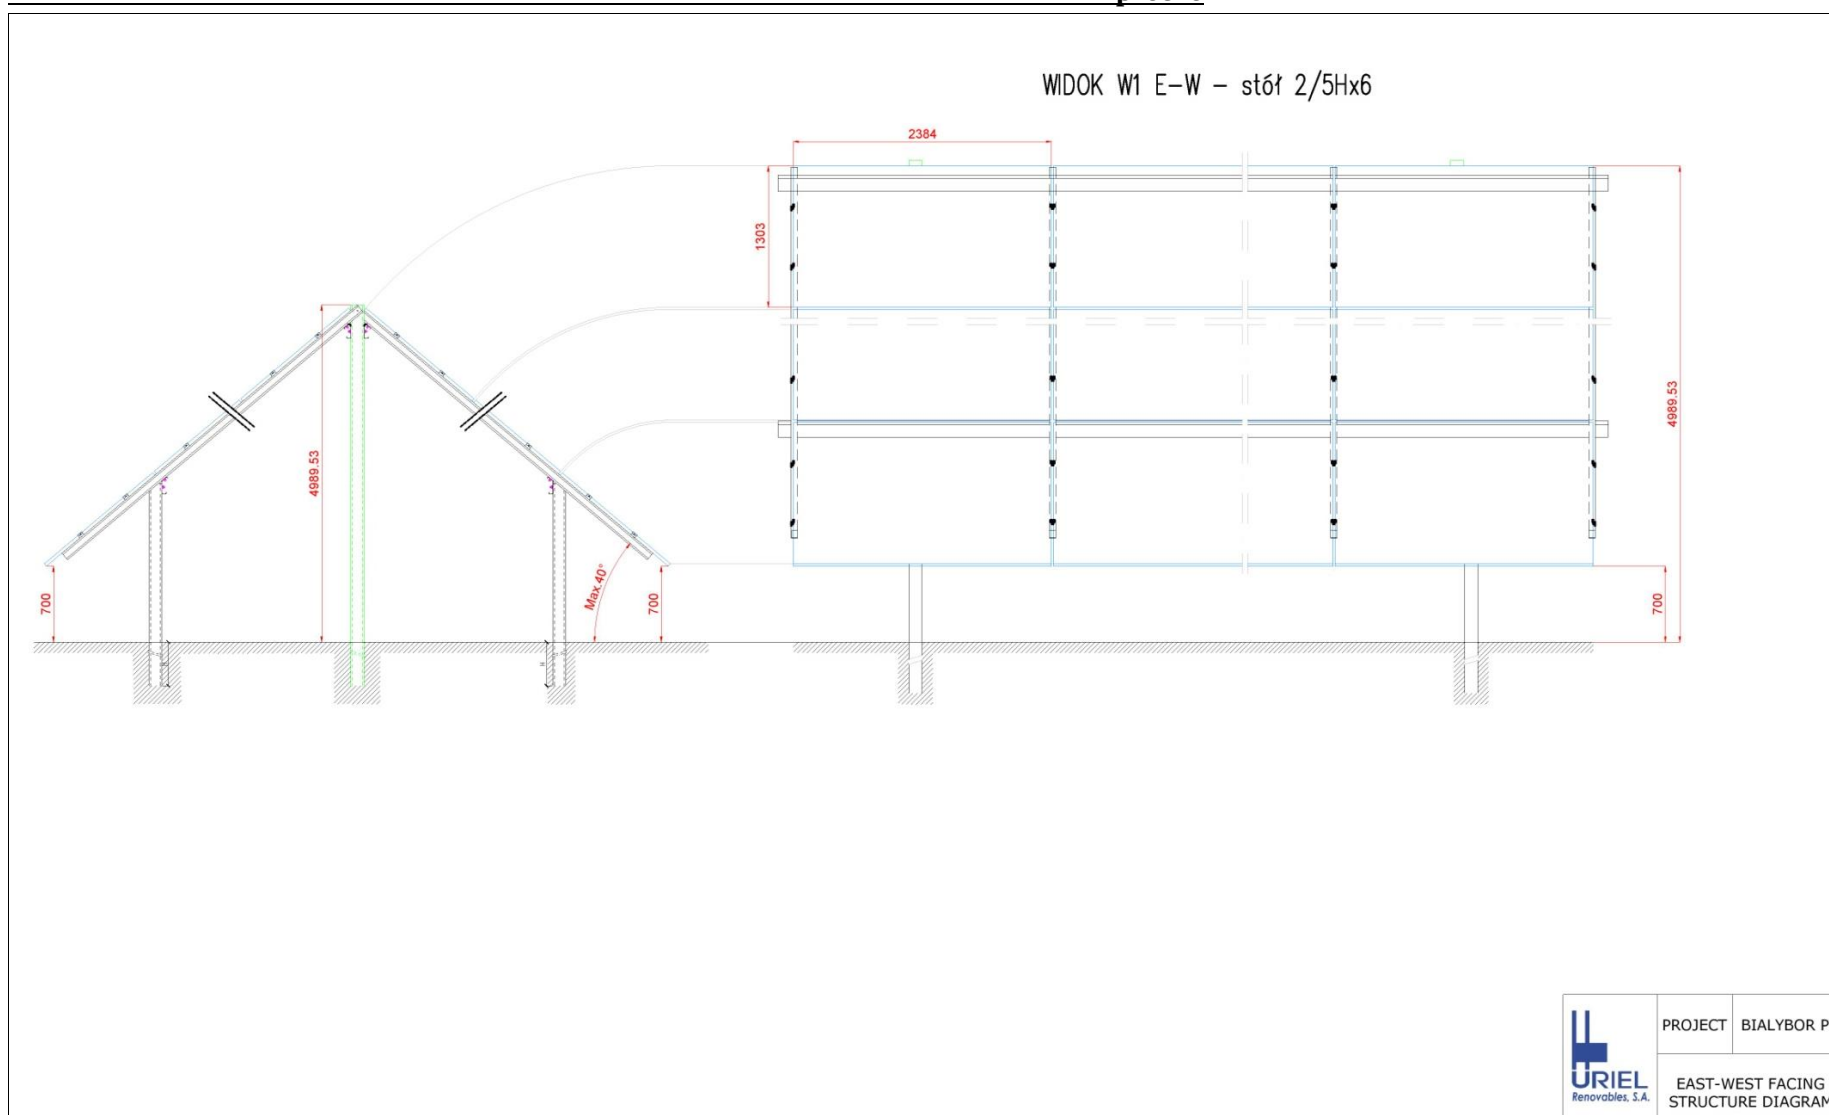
Przykład zespołu paneli fotowoltaicznych – pionowy układ paneli w dwóch rzędach.
